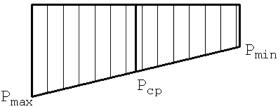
Построение эпюр напряжений по подошве фундамента.
